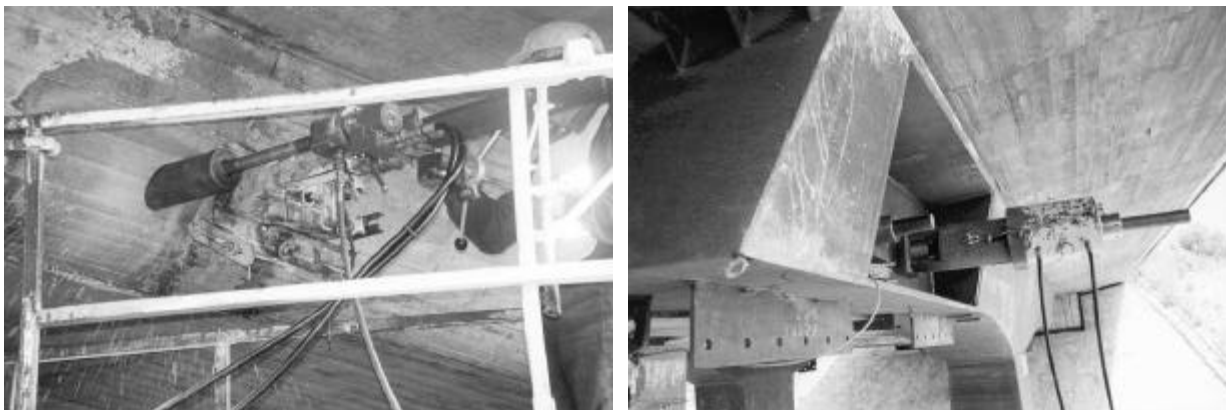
Ejecución de perforaciones en tablero y tesado de barras de pretensado
